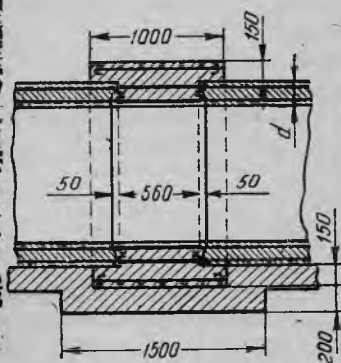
Конструкция муфты — заделки железобетонного монолитного трубопровода.
